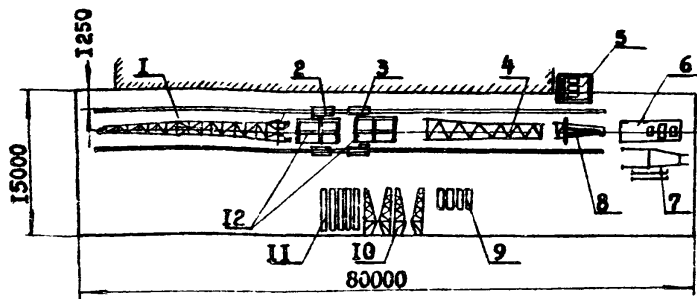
Схема укладки и монтажных элементов на монтажной площадке.
